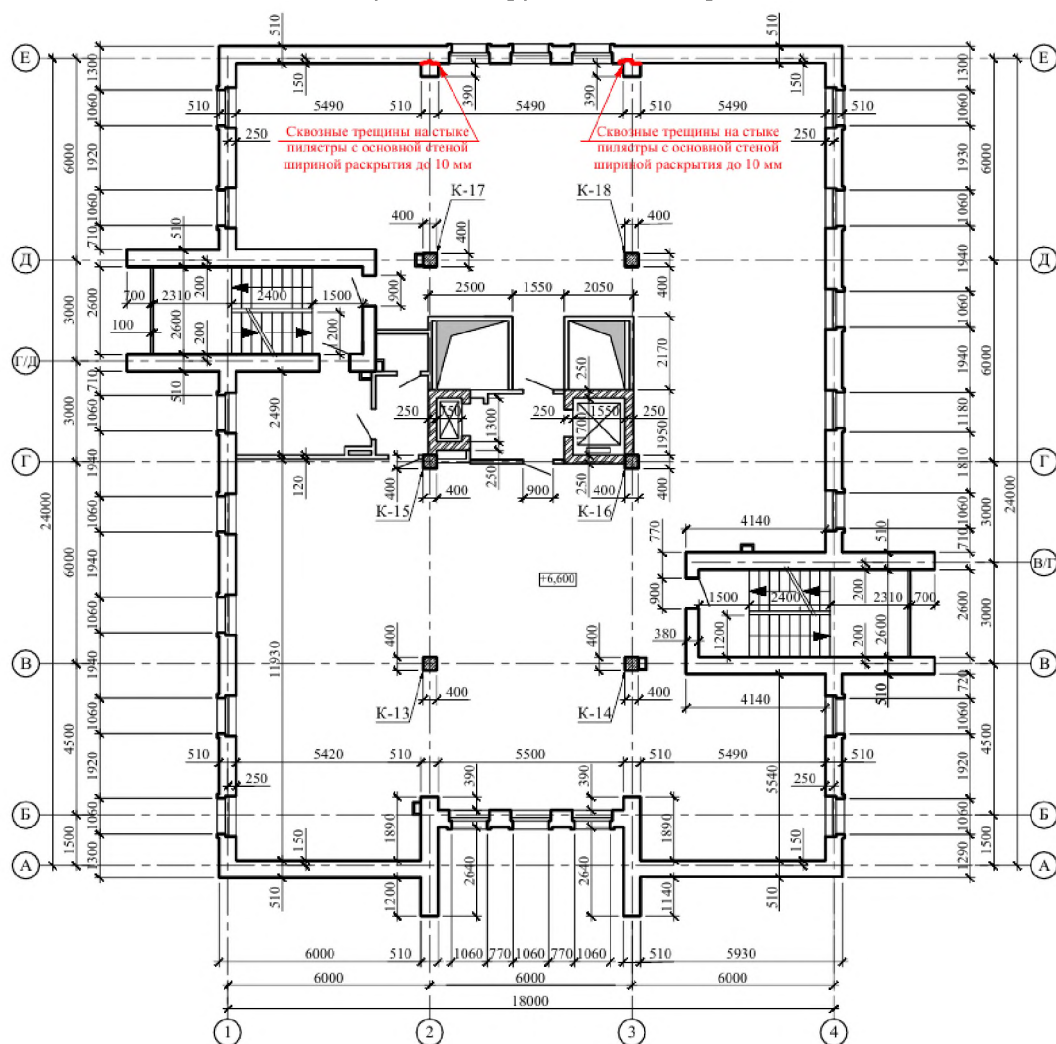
Расположение основных конструктивных элементов здания архива с указанием мест расположения сквозных трещин (план 3 этажа на отметке +6,600 м)
